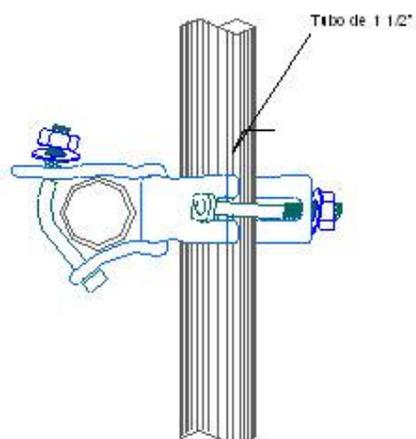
Tubo com braçadeira fixa. Fonte: ilustração Jorge Souza
